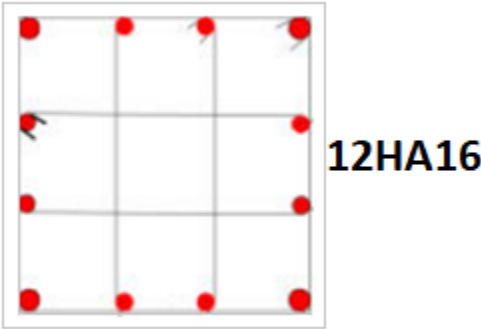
Schéma de ferraillage des poteaux de section 45 X 45 cm
